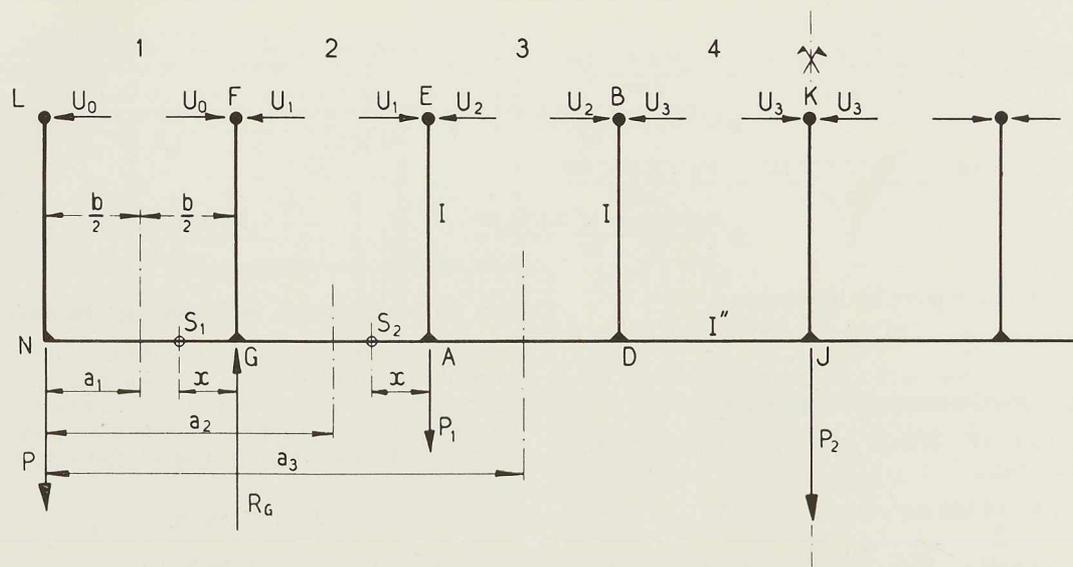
Schéma d'une poutre avec porte-à-faux.
